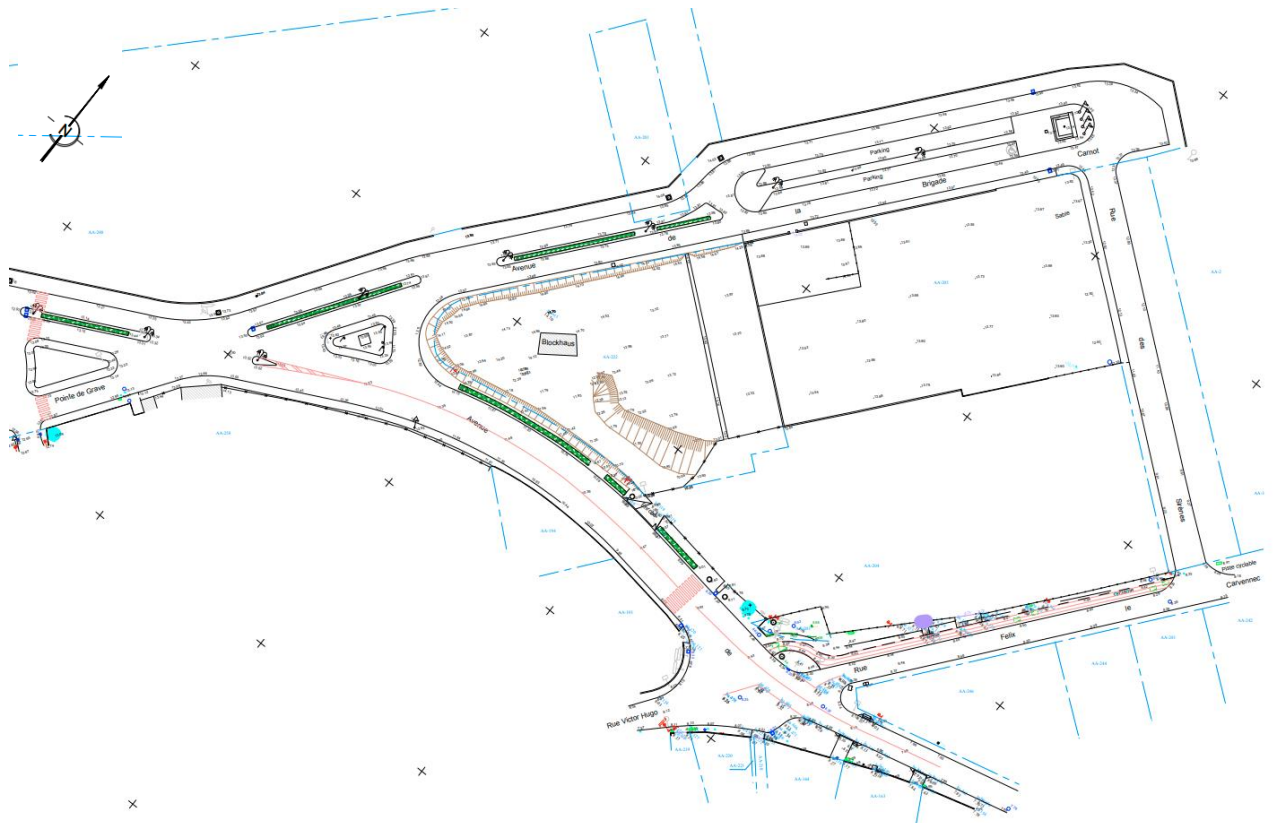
Plans de l'existant avant travaux (portion 5) (Source : PRO –juin 2018)
